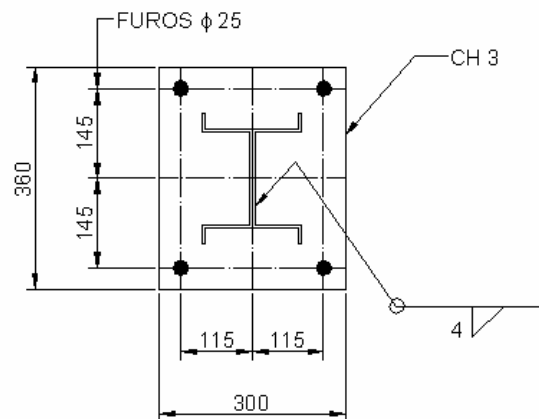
Detalhe construtivo da ligação Pilar – Fundação [3]
